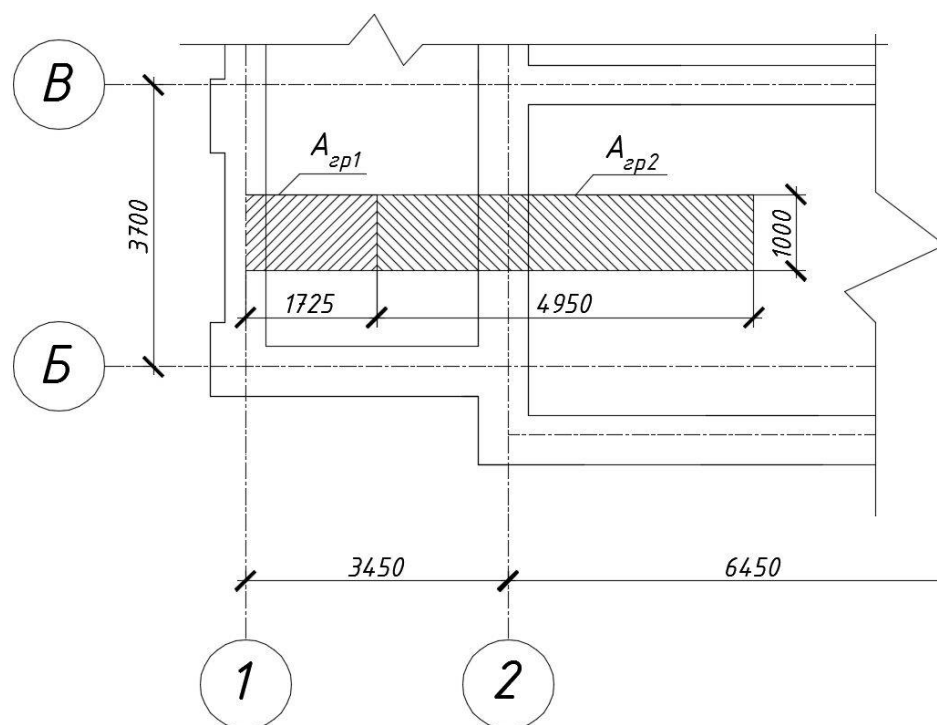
Фрагмент плана с грузовыми площадями для фундаментов, расположенных в осях 1/Б-В и 2/Б-В
